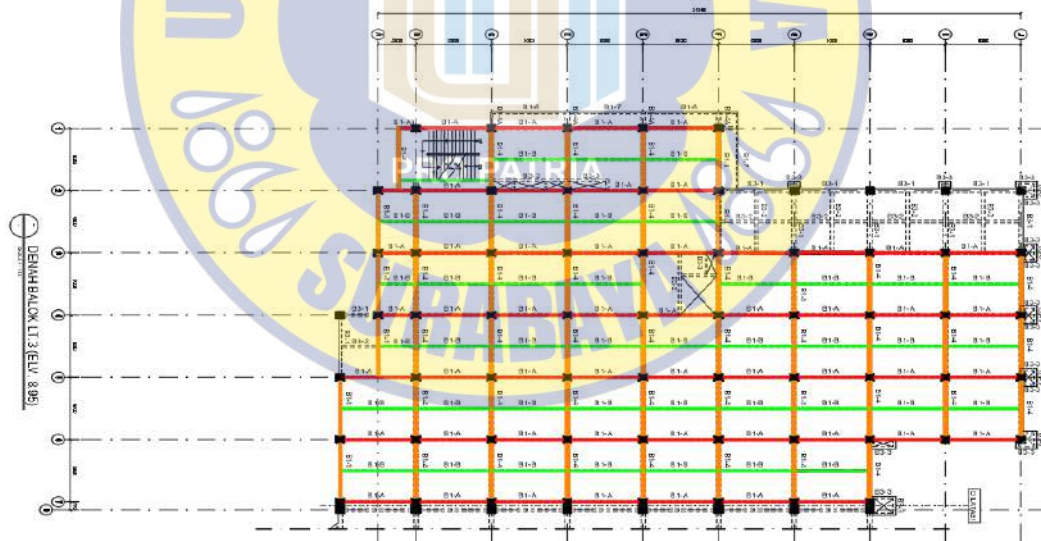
30 Mapping Denah Titik Chemset Lantai 2 A1
